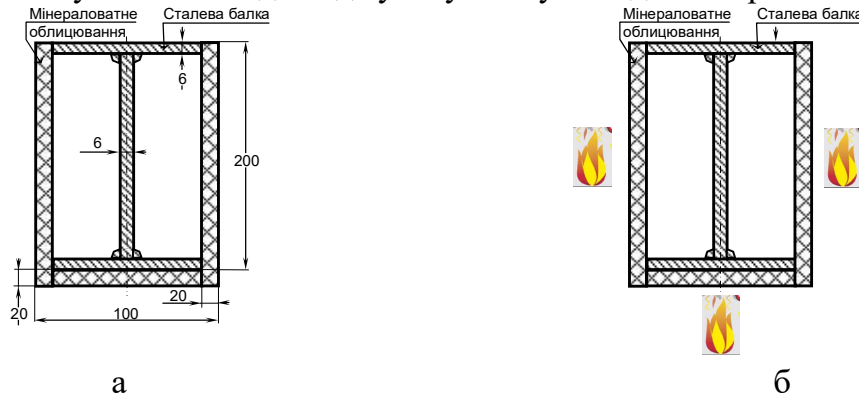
Геометрична схема перерізу сталеві балки із мінераловатним вогнезахисним облицюванням (а) та схема теплового впливу пожежі на переріз балки.
